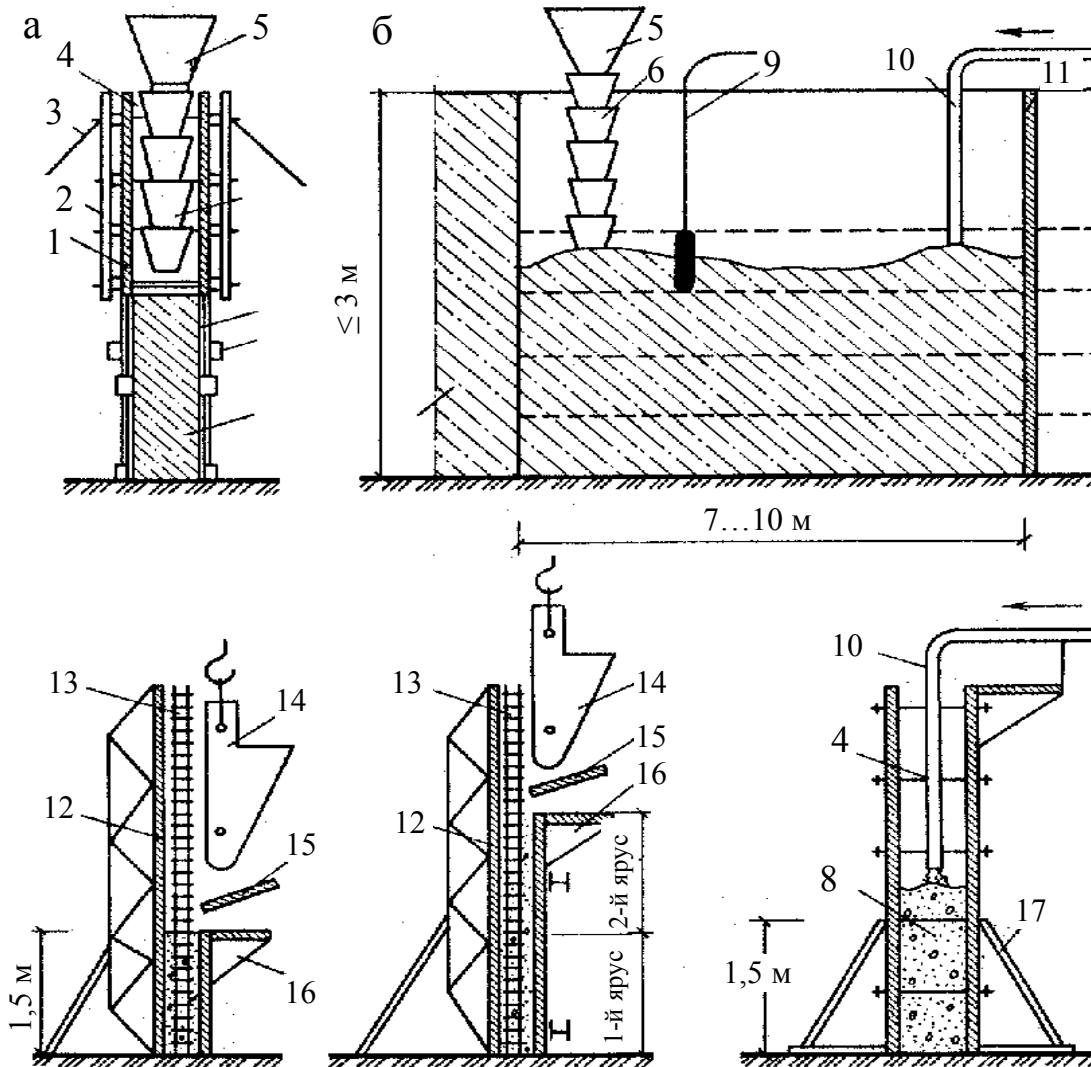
Схема бетонування стін підземних споруд: а – стін завтовшки 0,5 м і більше, висотою 3 м; б – тонких стін; в – пошарове бетонування стін бетононасосами;
